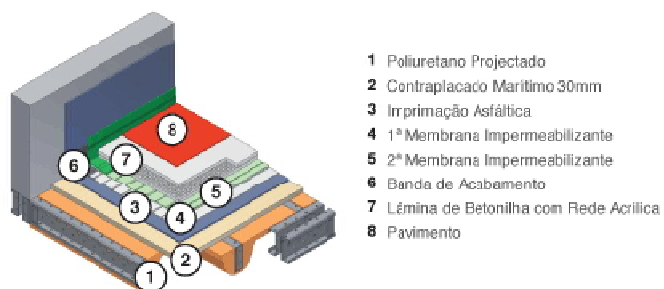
Pormenor construtivo de cobertura plana transitável (TÉKETO, 2010)
